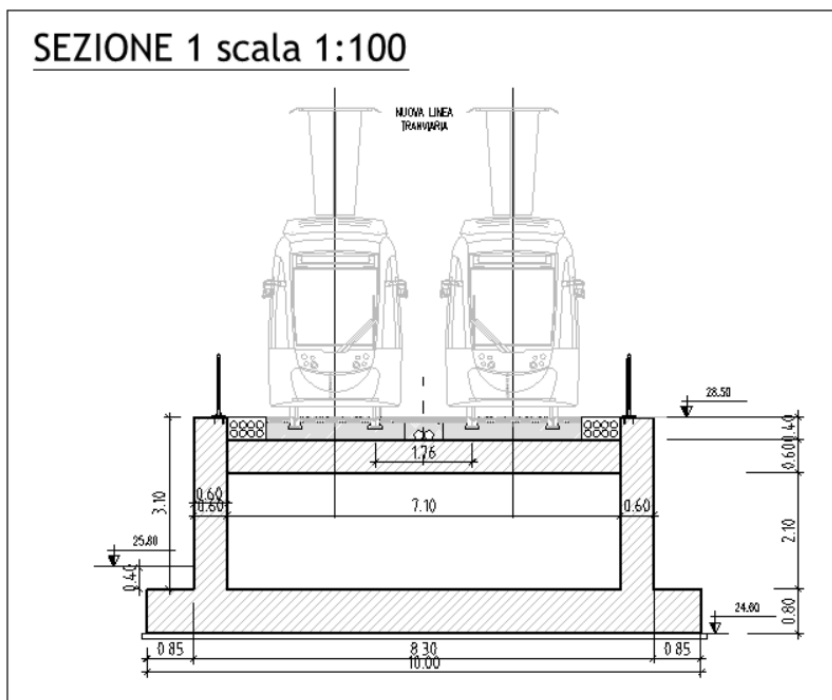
Sezione trasversale 1-1 primo tratto
